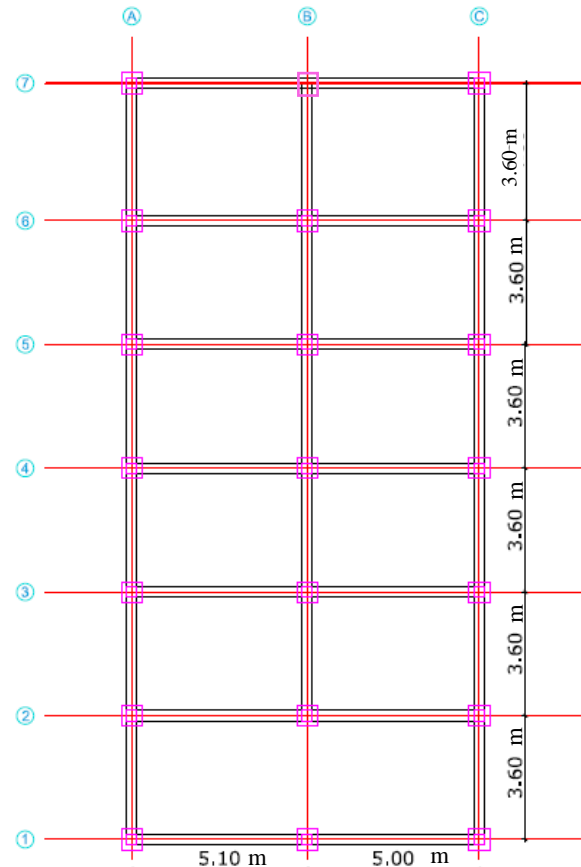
Vista en planta Edificio. Fuente: Autoría Propia.
